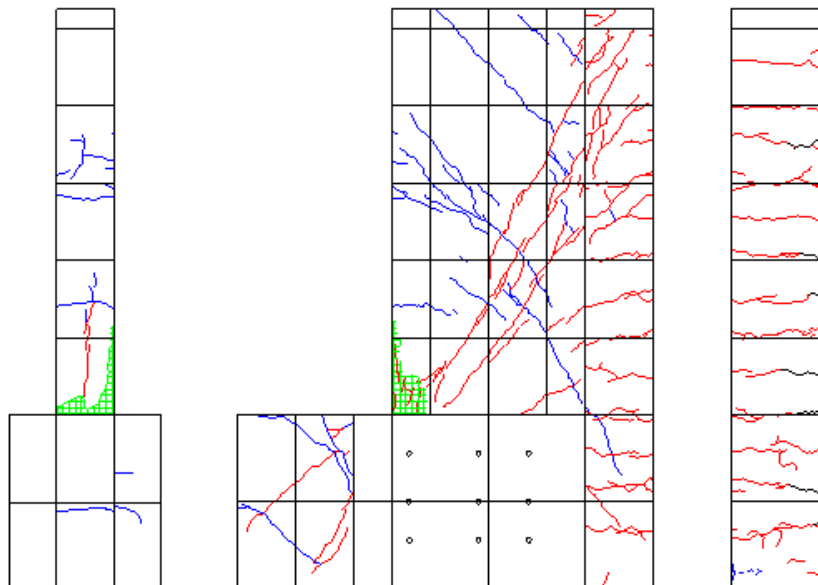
R=-1/50②ひび割れ図
